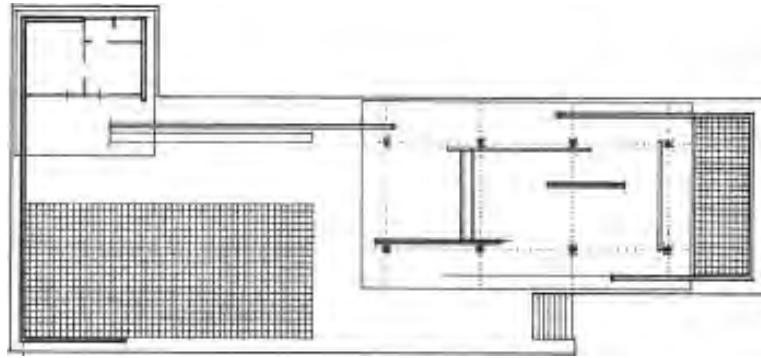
Pabellón de Barcelona de Mies Van der Rohe, ejemplo de utilización de planta libre.
